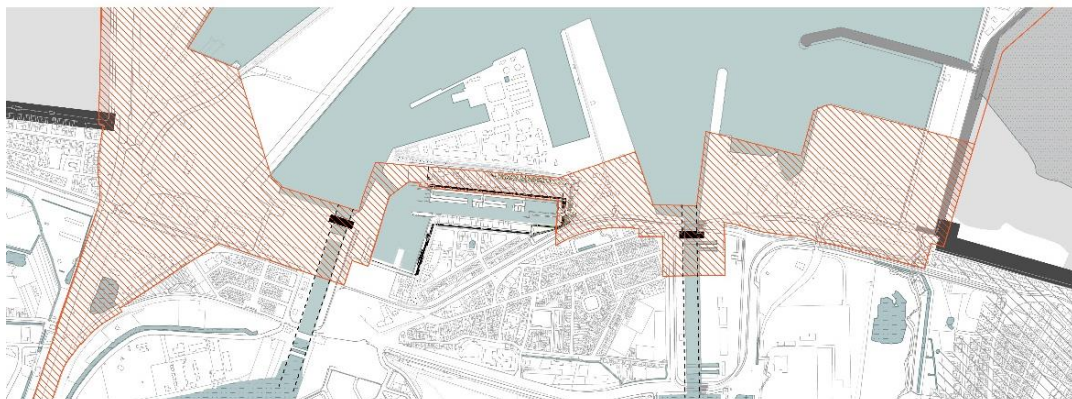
Alternatief Open havenmond + sluis jachthaven in Zeebrugge
